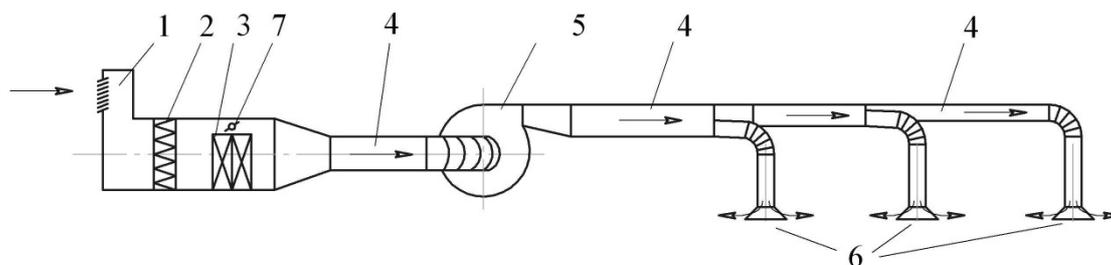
Схема приточной вентиляционной системы: 1 – воздухозаборное устройство; 2 – фильтр; 3 – воздухонагреватель; 4 – воздуховоды; 5 – вентилятор; 6 – воздухораспределитель; 7 – воздушный клапан с ручным или электрическим приводом
